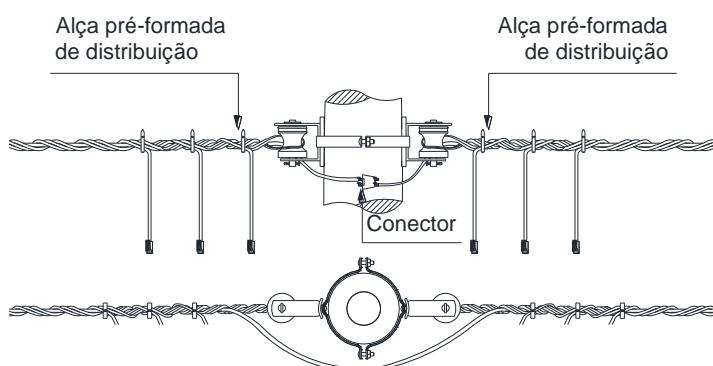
Amarrações e ligações – Estrutura secundária – Fim de rede
